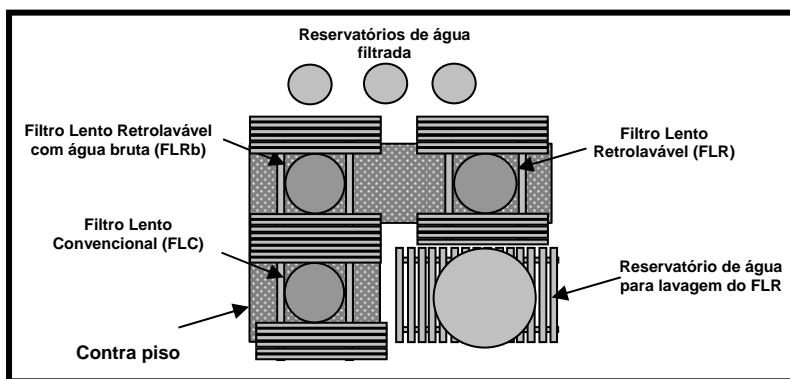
Desenho esquemático de disposição dos filtros, vista em planta
